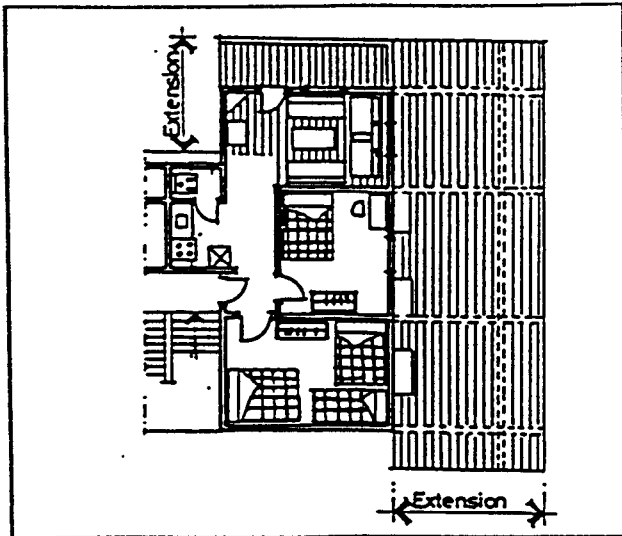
Denah ruang tambahan pada rumah bersusun di Helwan, tersedia untuk pengembangan
